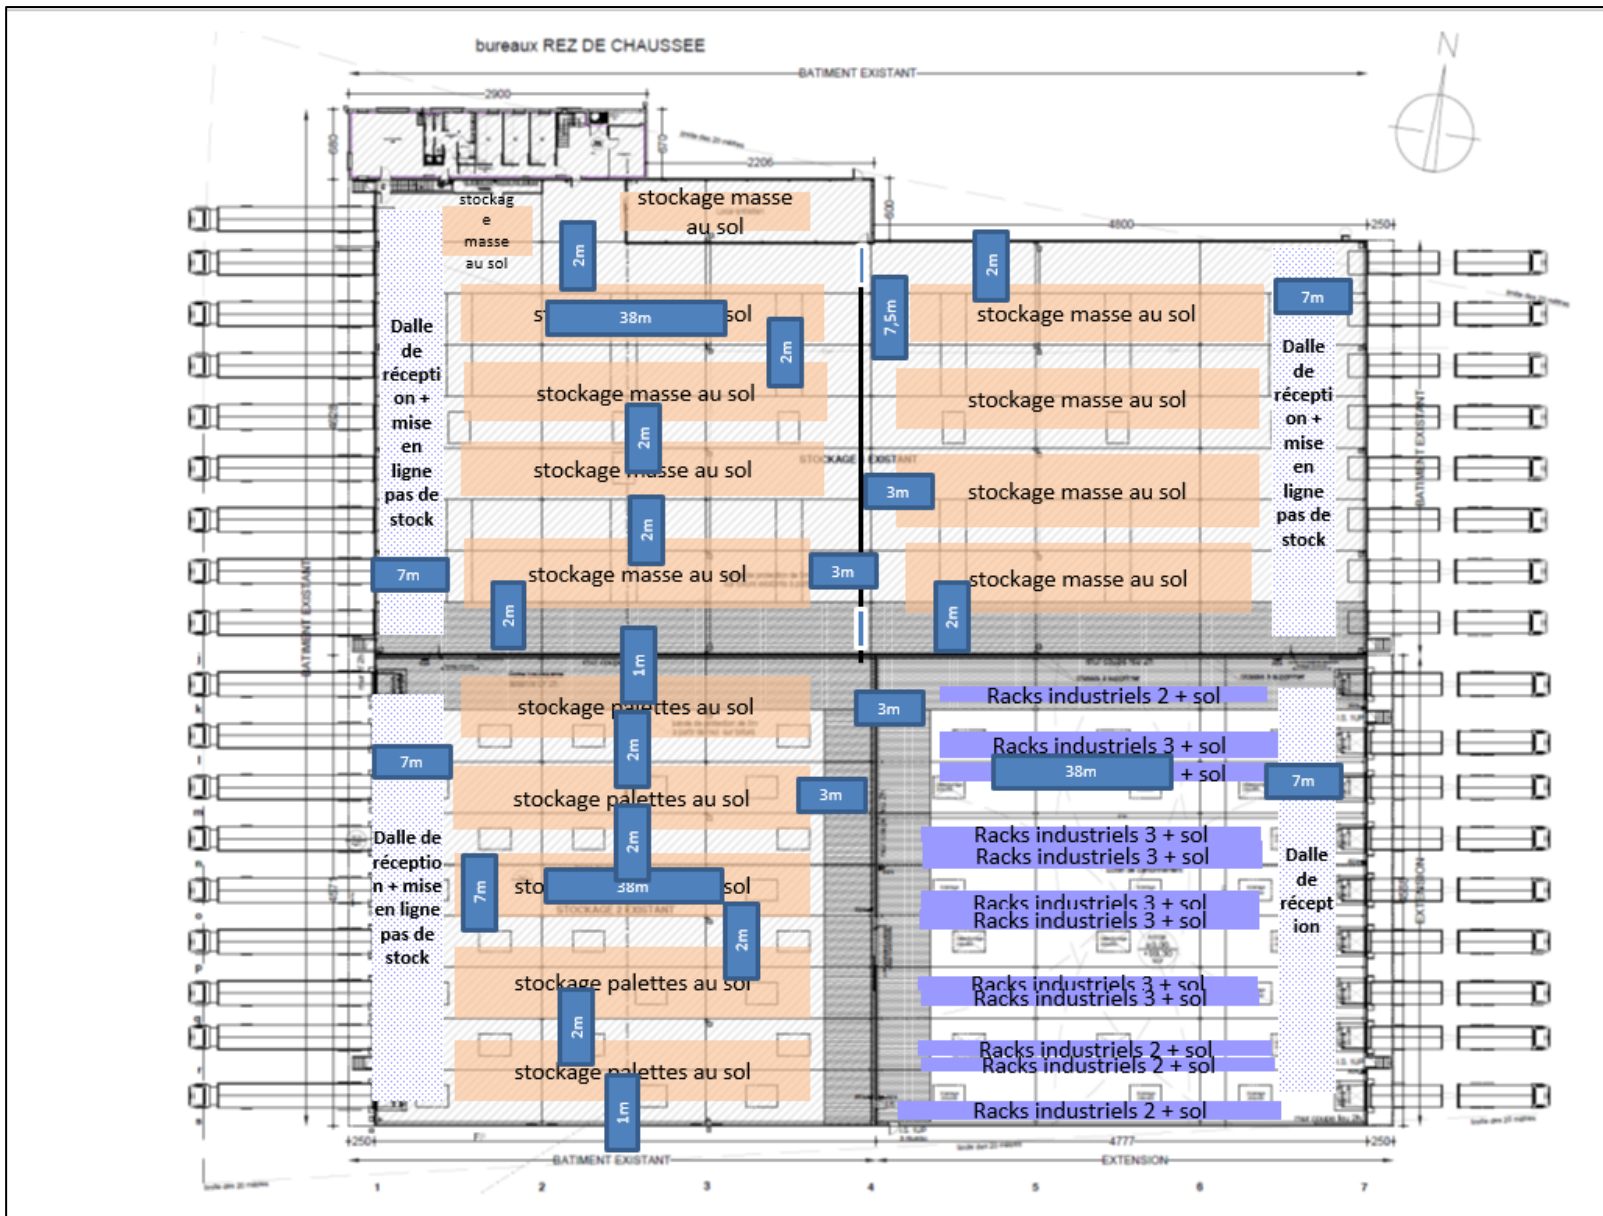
Plan des stockages projetés. Source : GROUPE GUISNEL
